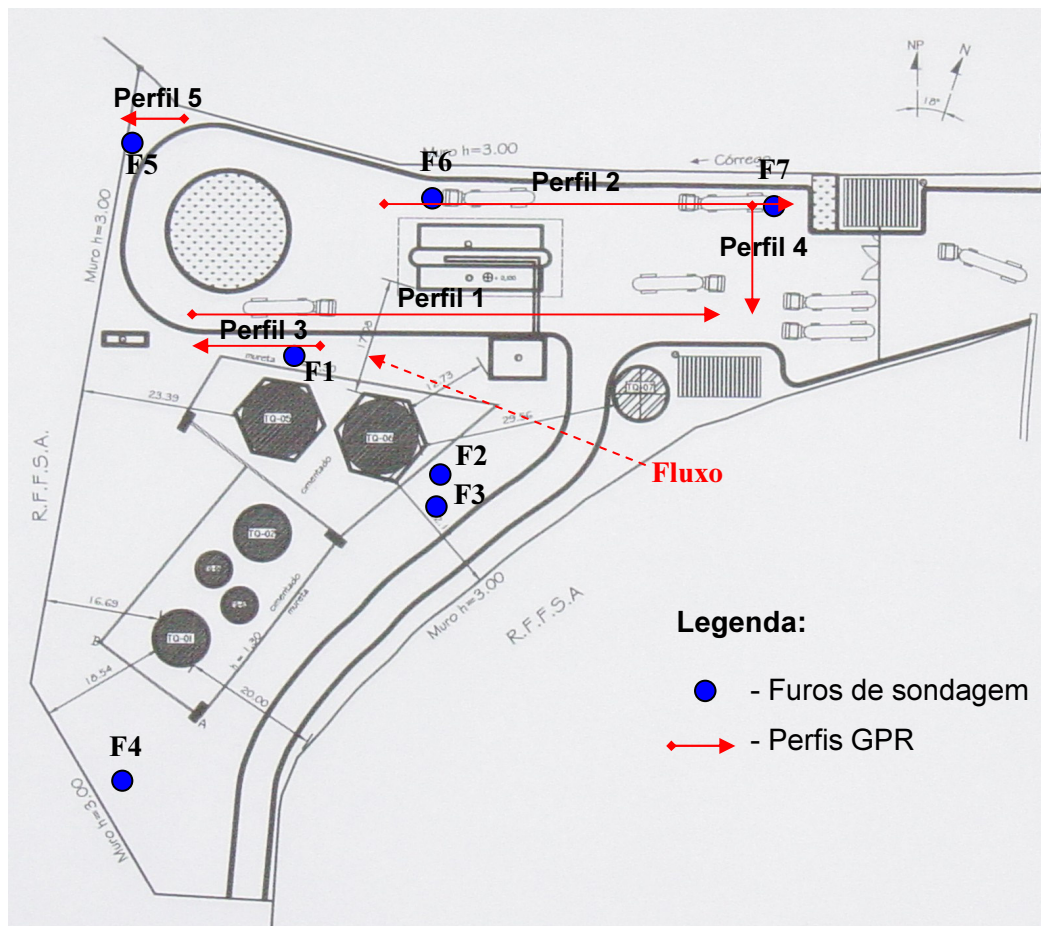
Planta de situação com a direção dos perfis GPR e localização dos furos de sondagem
